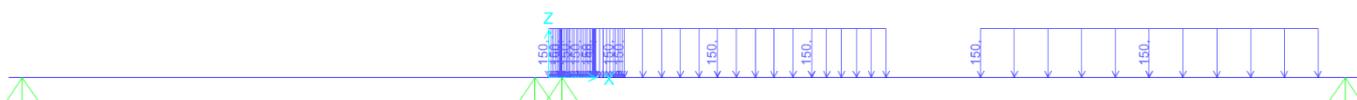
disposizione di carico 2 - SW/2 – pila 3
